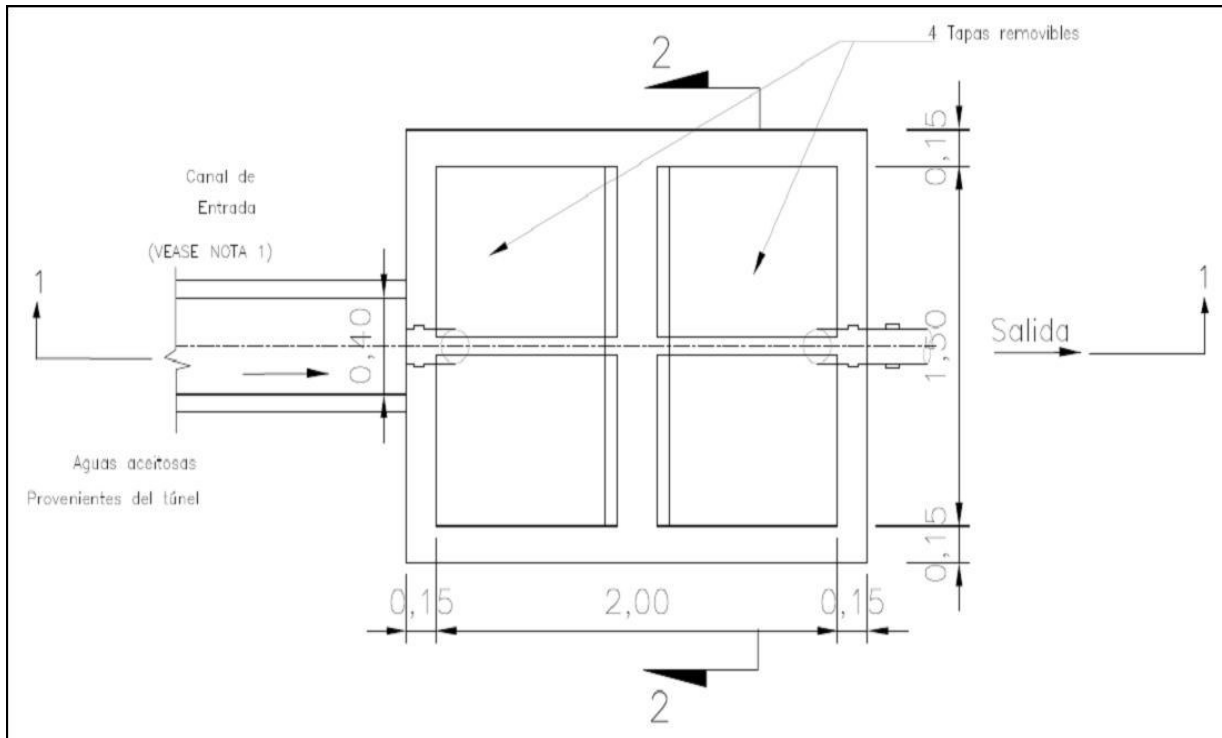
Planta general trampa de grasas para aguas aceitosas provenientes de la construcción del túnel
